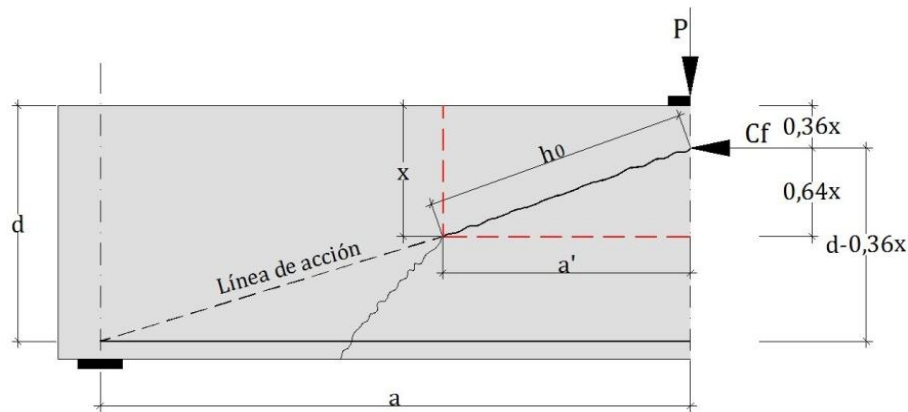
Mecanismos de fisuración en vigas esbeltas [10]
